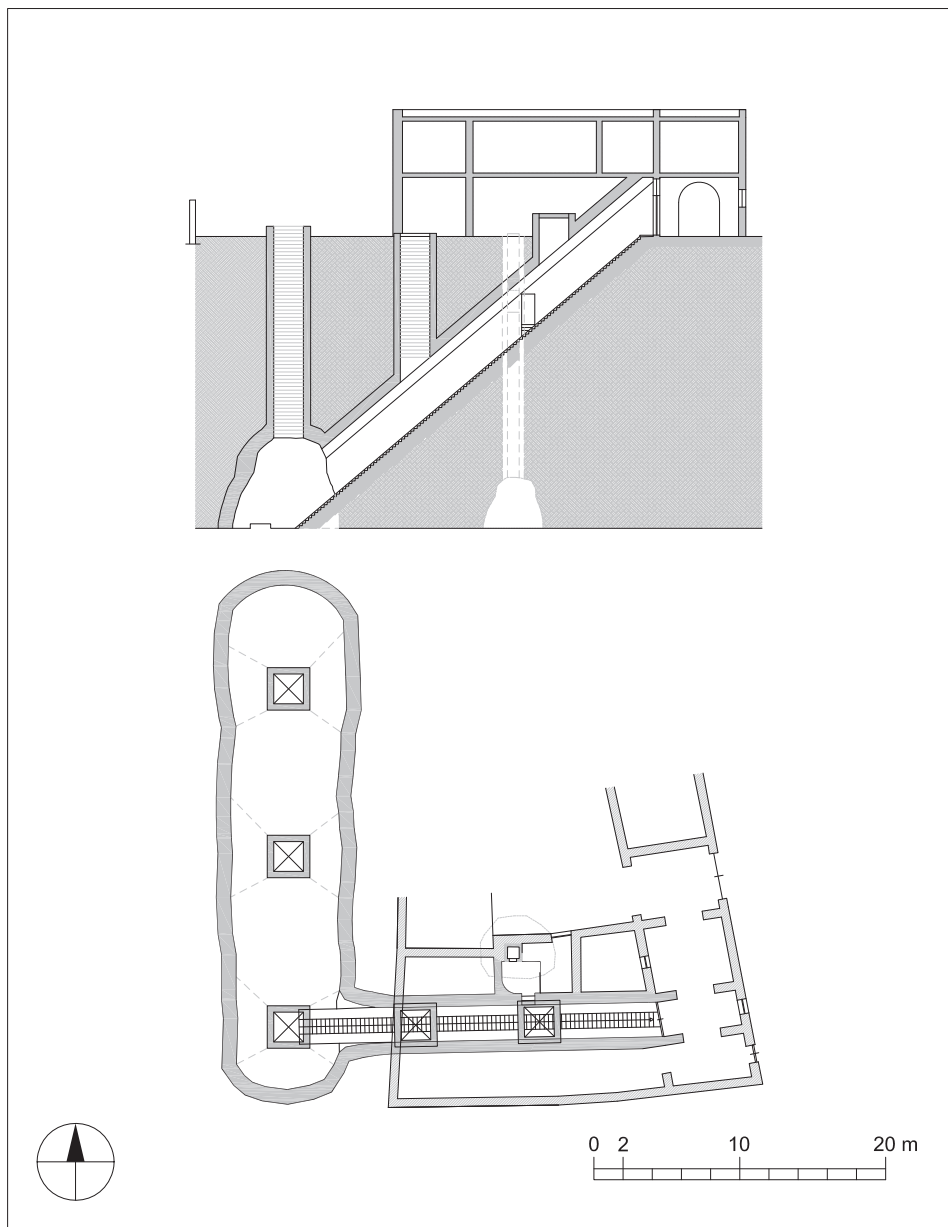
Comiziano, cantina C4. Pianta e sezione trasversale.
